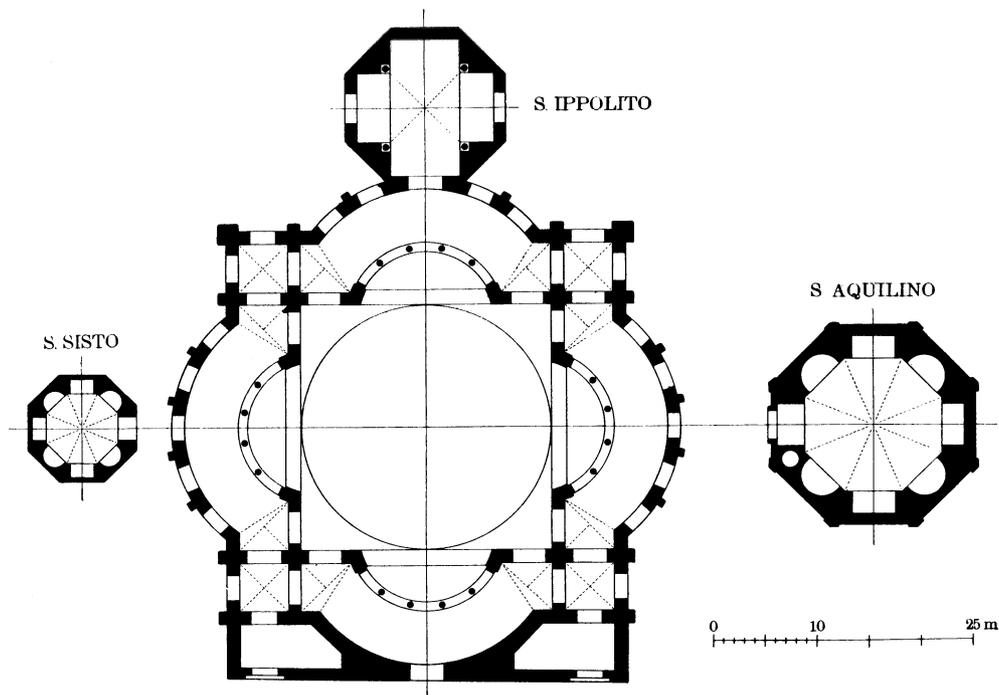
Unterer Grundriß des Baues des 6. Jahrhunderts, mit den Kapellen. 1 : 750.
